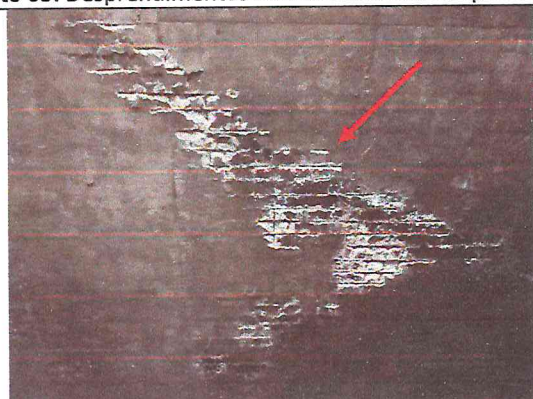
Laje apresentando recobrimento insuficiente do concreto e exposição de armaduras
